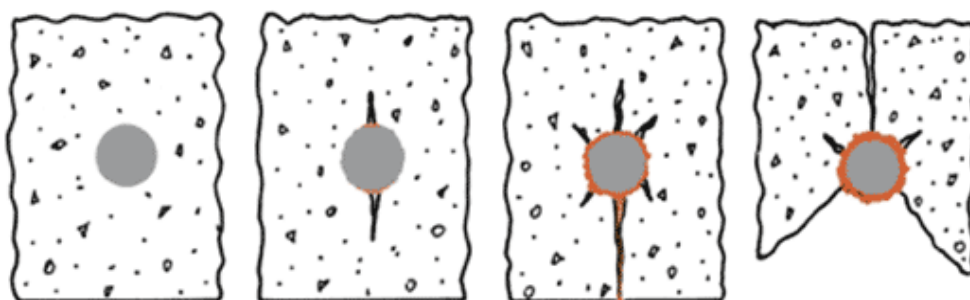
Руйнування бетону захисного шару внаслідок корозії арматури
